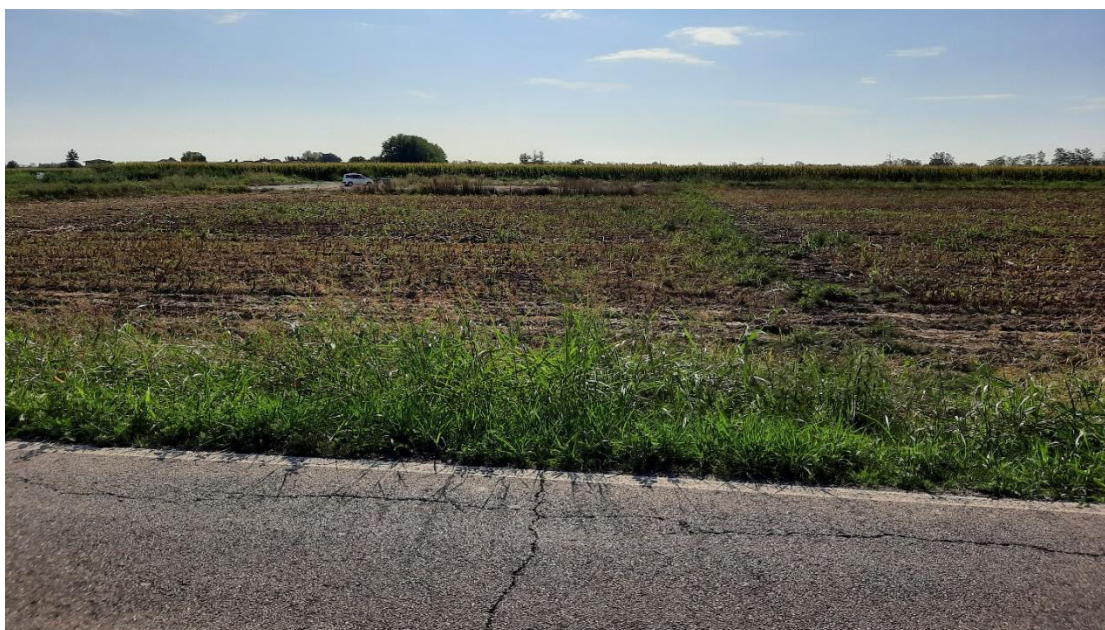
Vista da via Cotrebbia Nuova in direzione est dell'area oggetto di intervento.
